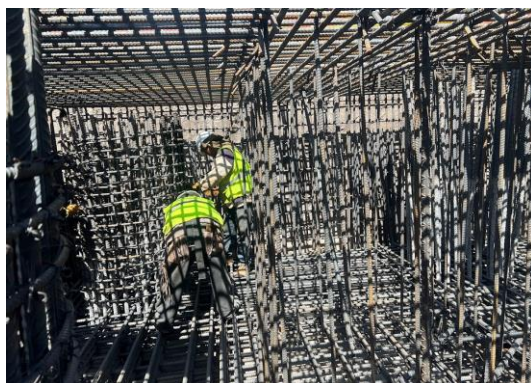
y 104 Autoría Propia (2023) "Supervisión de estribos restantes en pilas de cimentación, estribos en zapatas, recubrimiento inferior y diámetros de varilla"
